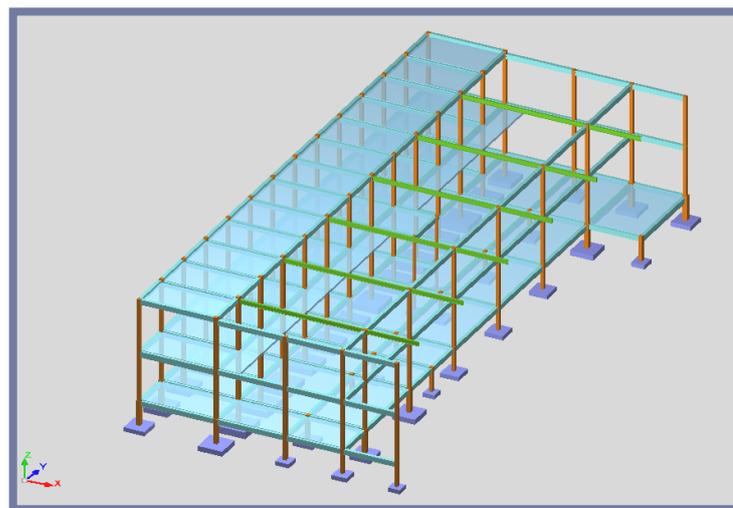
Modelado Estructural en 3D con CypeCad (2012).
